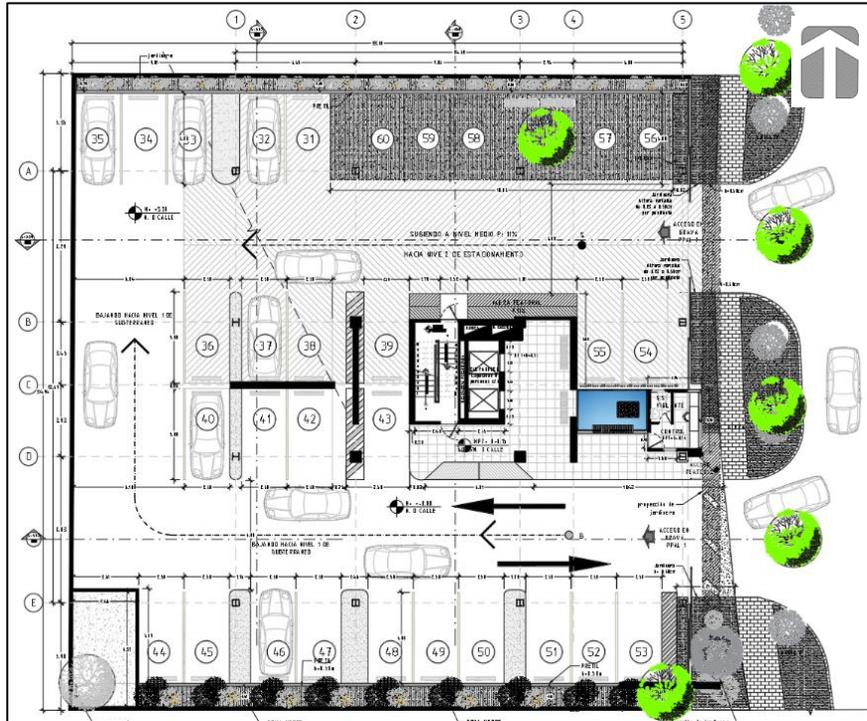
PLANTA DE ESTACIONAMIENTO NIVEL 1 DE CALLE. FUENTE: MR ARQUITECTURA CONCEPTO
